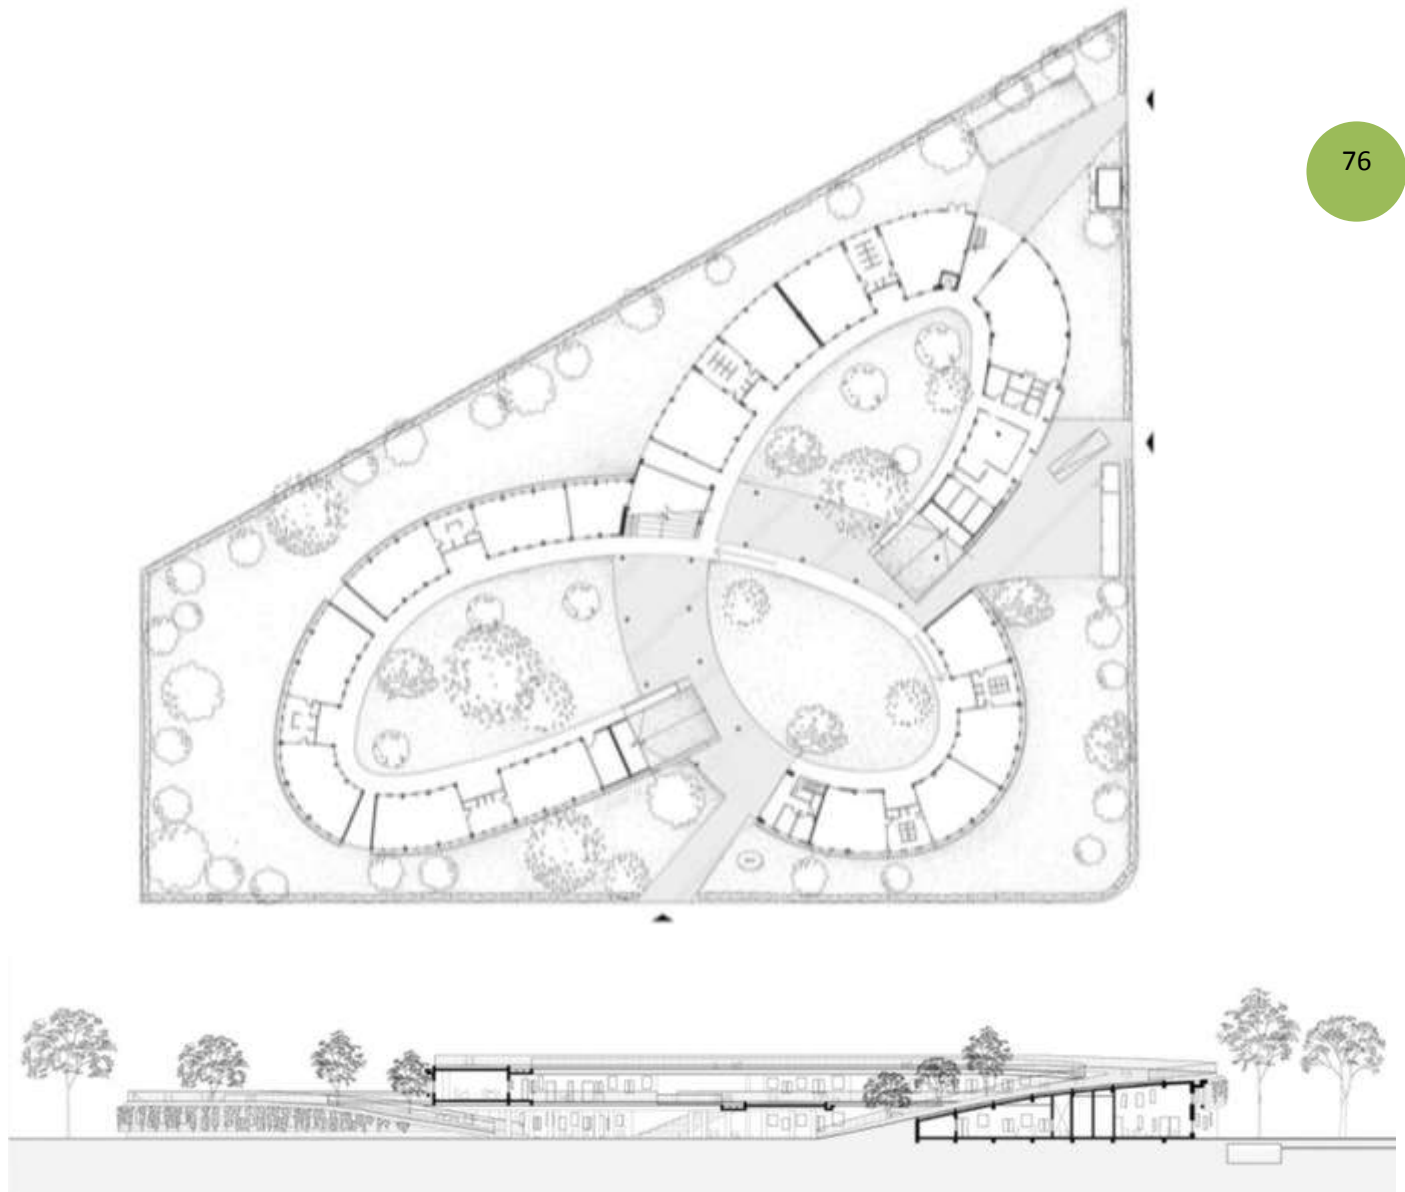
Vistas de todos los componentes construidos estructurales y cerramientos del Jardín Infantil Farming.
